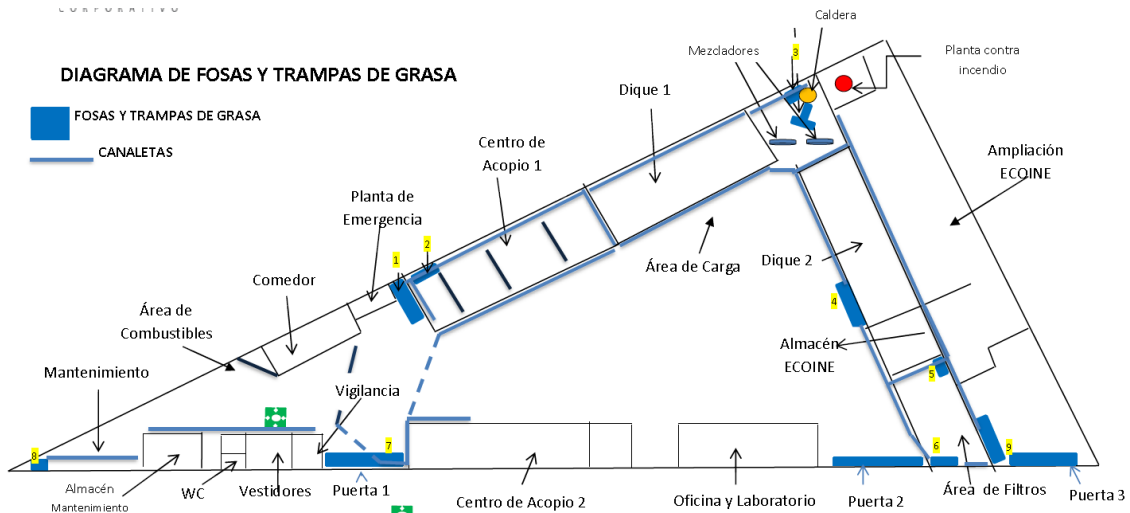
Plano de ubicación de las fosas y trampas de grasa
